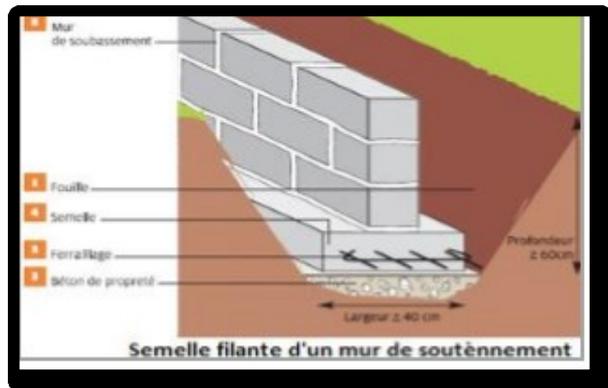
Schéma représentant d'une semelle filante d'un mur de soutènement.¹
